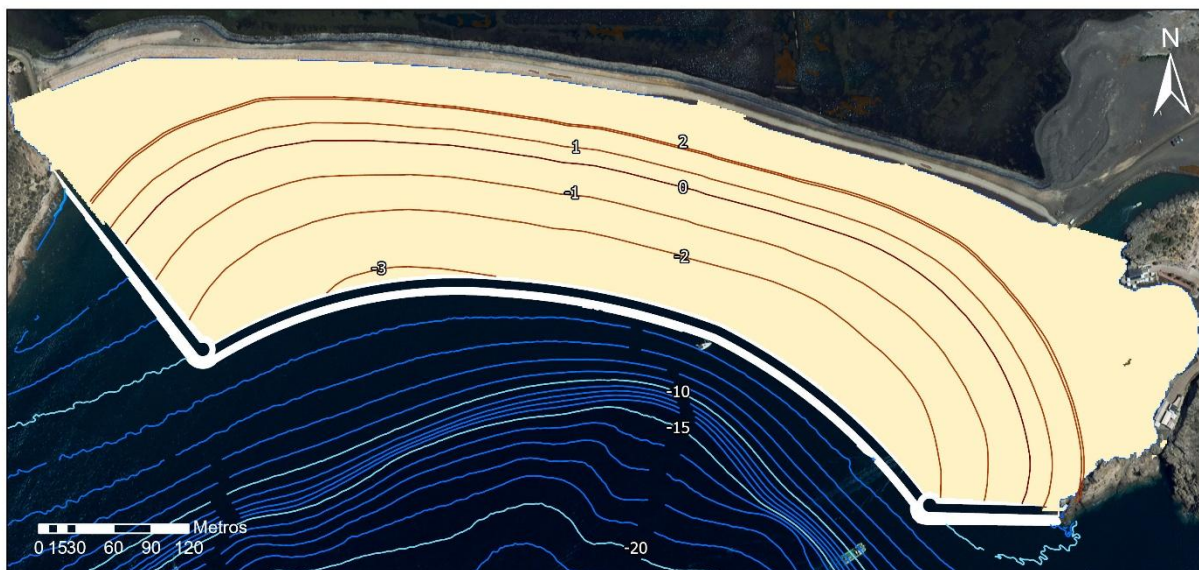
Vista en planta de la Alternativa 2A (idéntica a la 1A).
